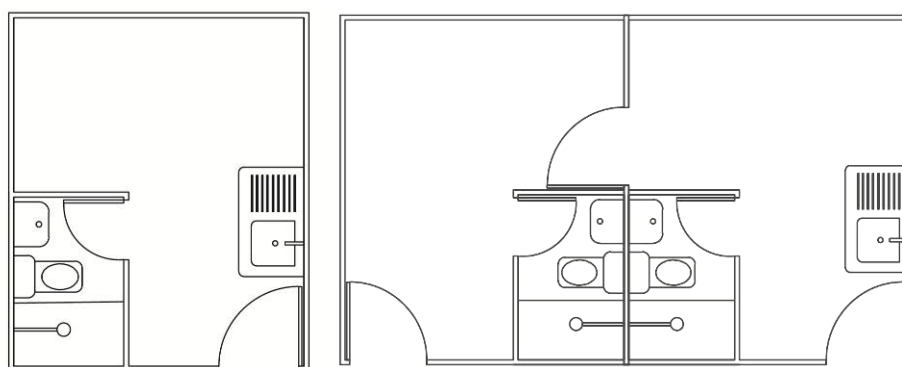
A) Planta de 1 módulo B) Planta de 2 módulos.
